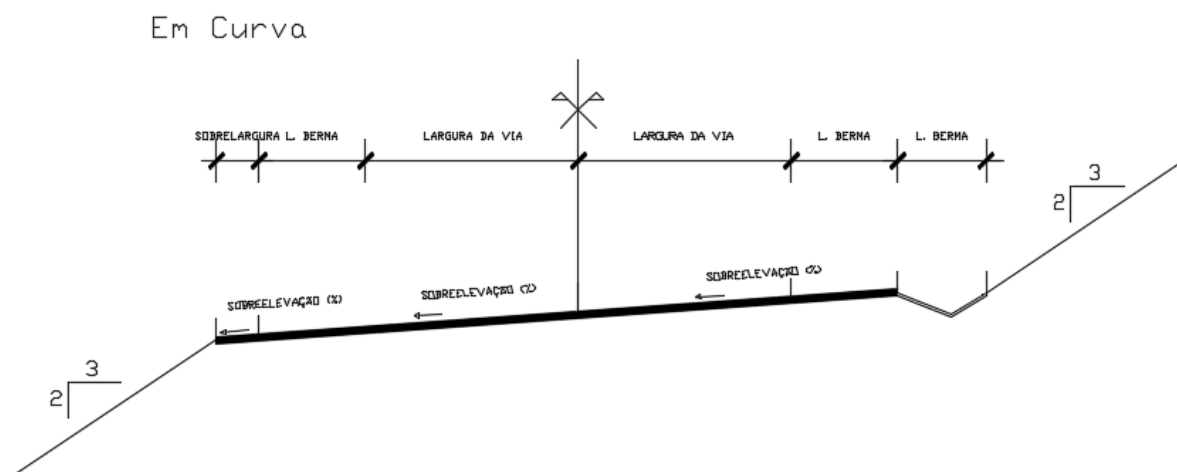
Perfil transversal tipo em curva na zona de sobrelevação máxima
